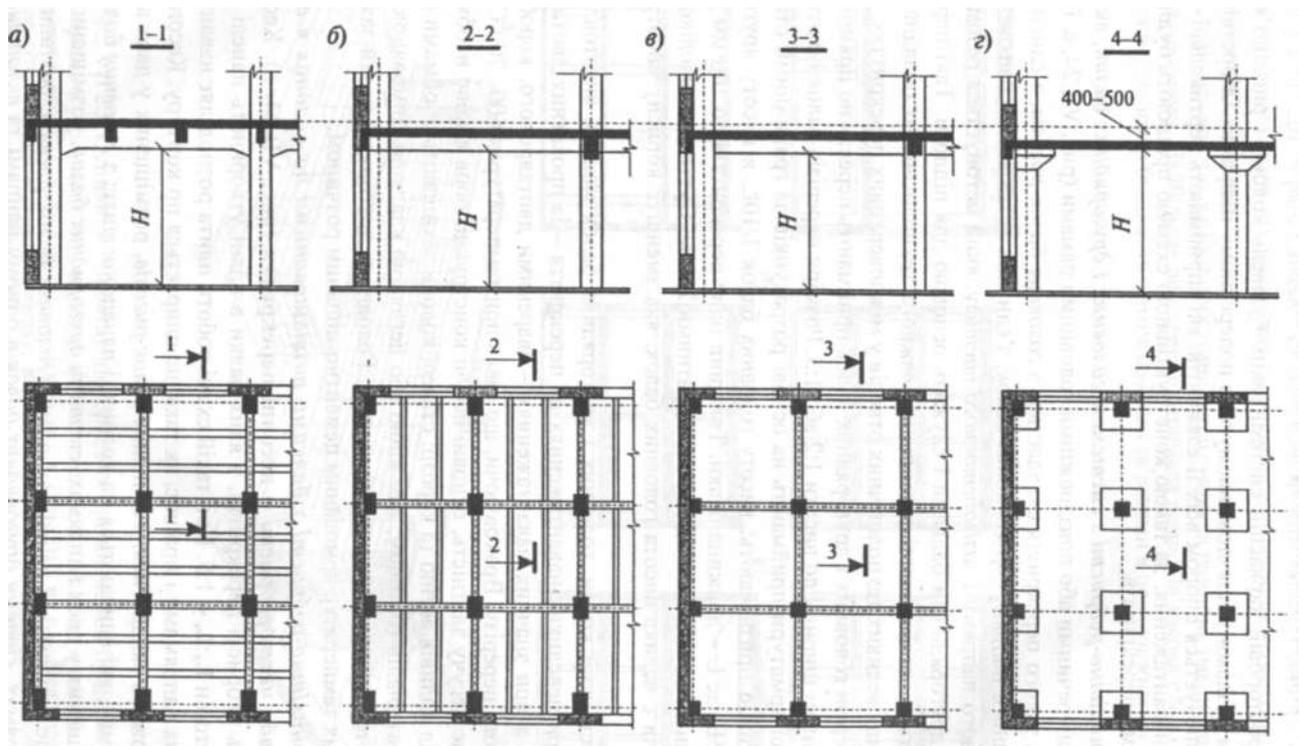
Схеми монолітних залізобетонних каркасів багатоповерхових будівель (розрізи і плани):
